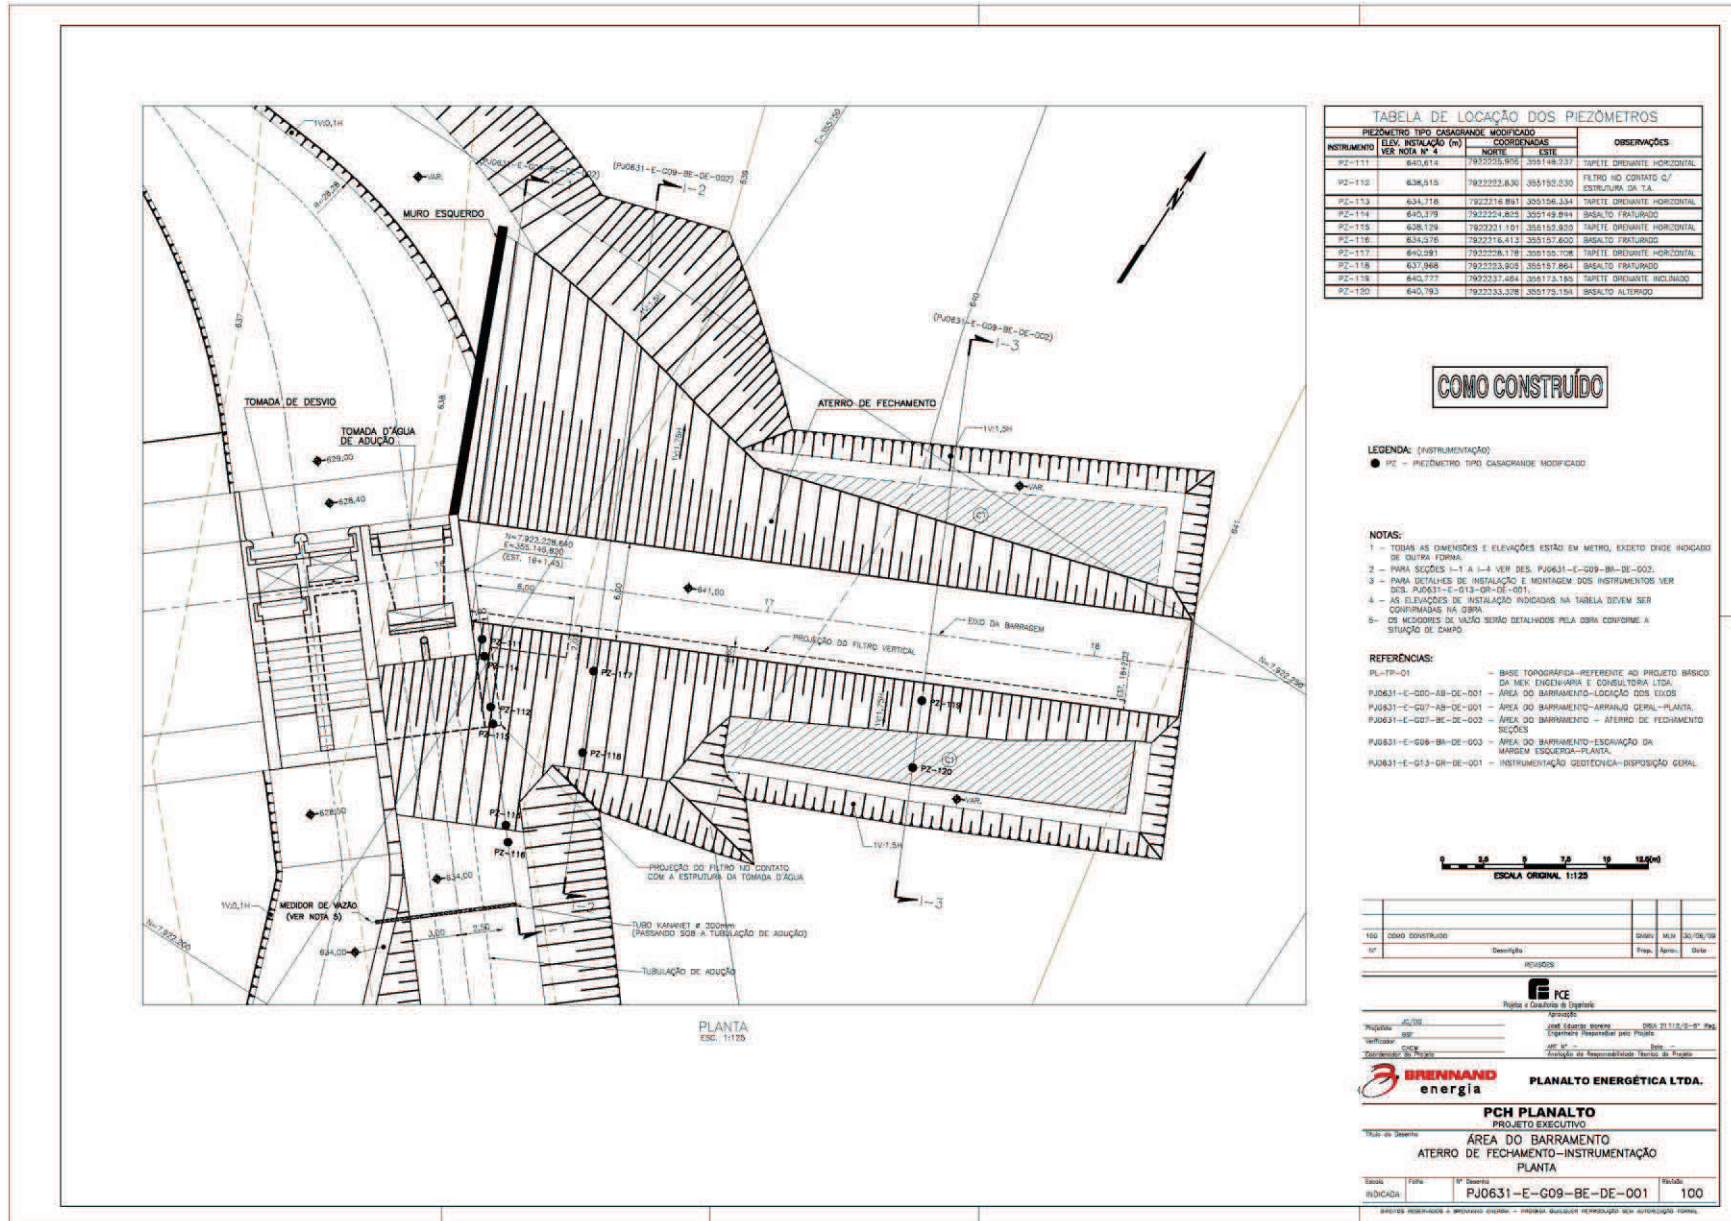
Barragem Margem Esquerda – Instrumentação Planta
